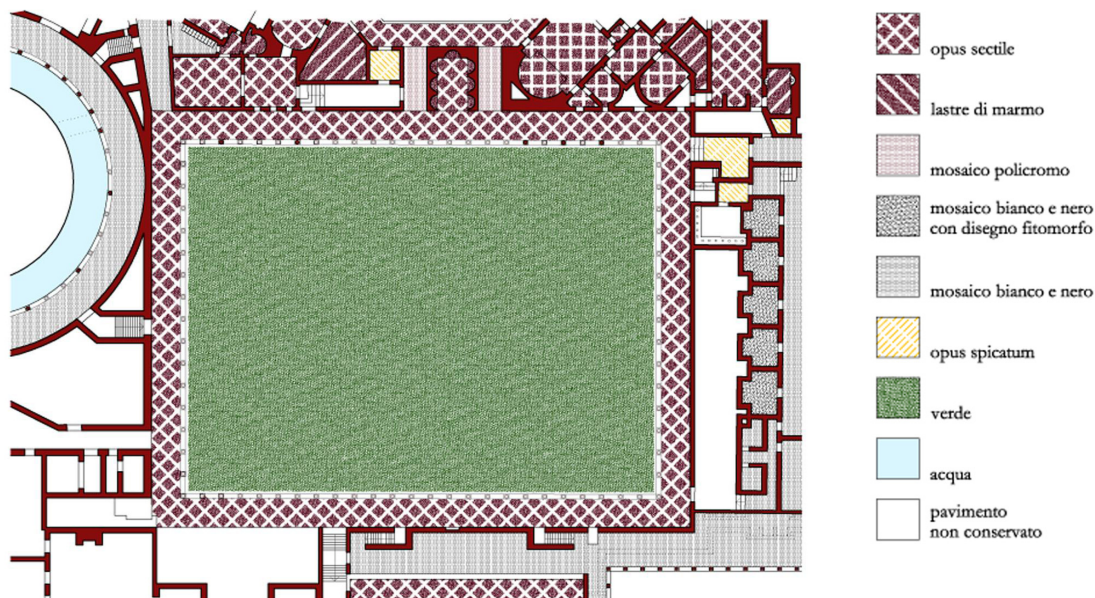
Planta del patio de las Bibliotecas con indicación del tipo de pavimentos.¹⁸⁵
